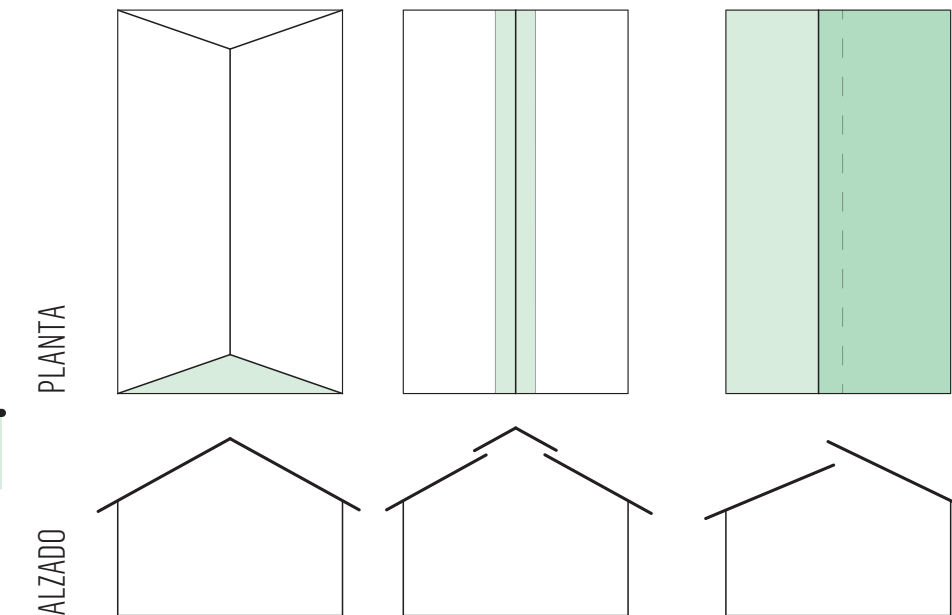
Componente C, Tipología cubiertas Fuente: Propia
